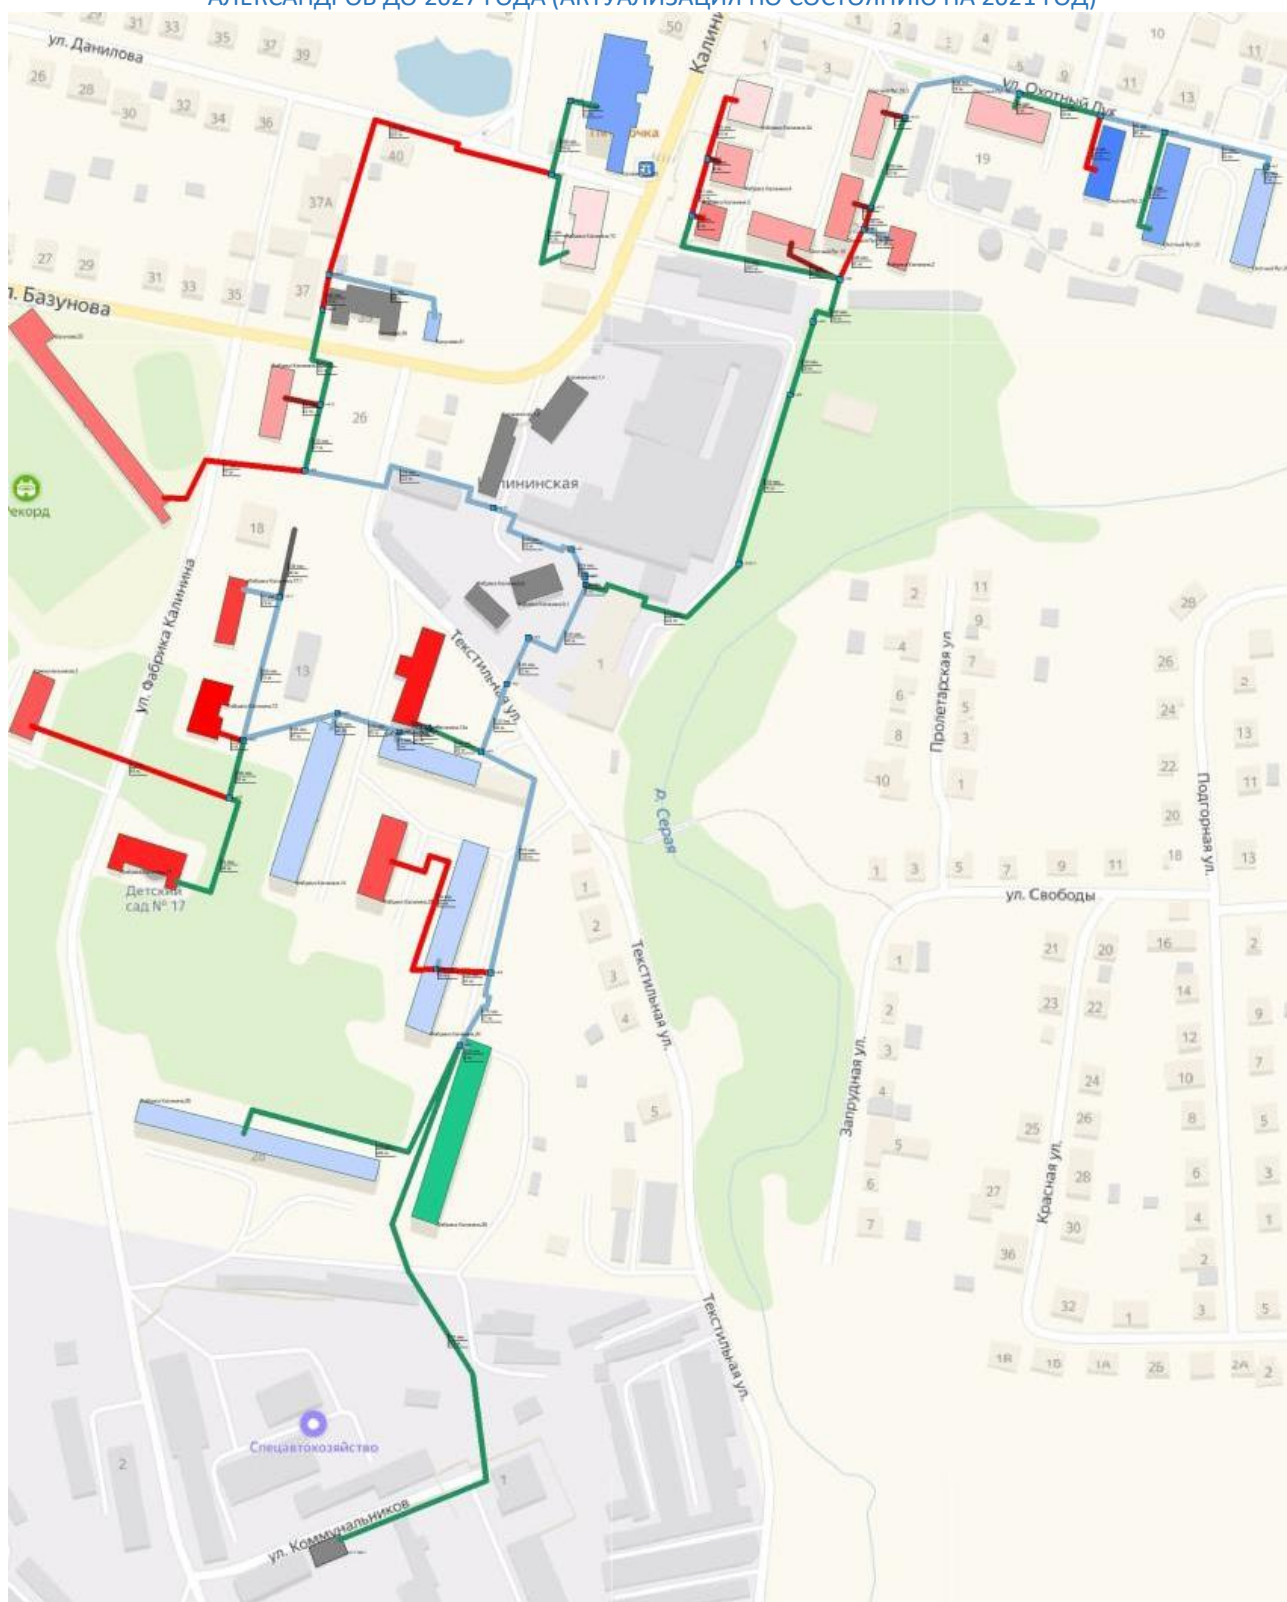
Котельная №8 с переключением нагрузок от котельной №3 и котельной №4
